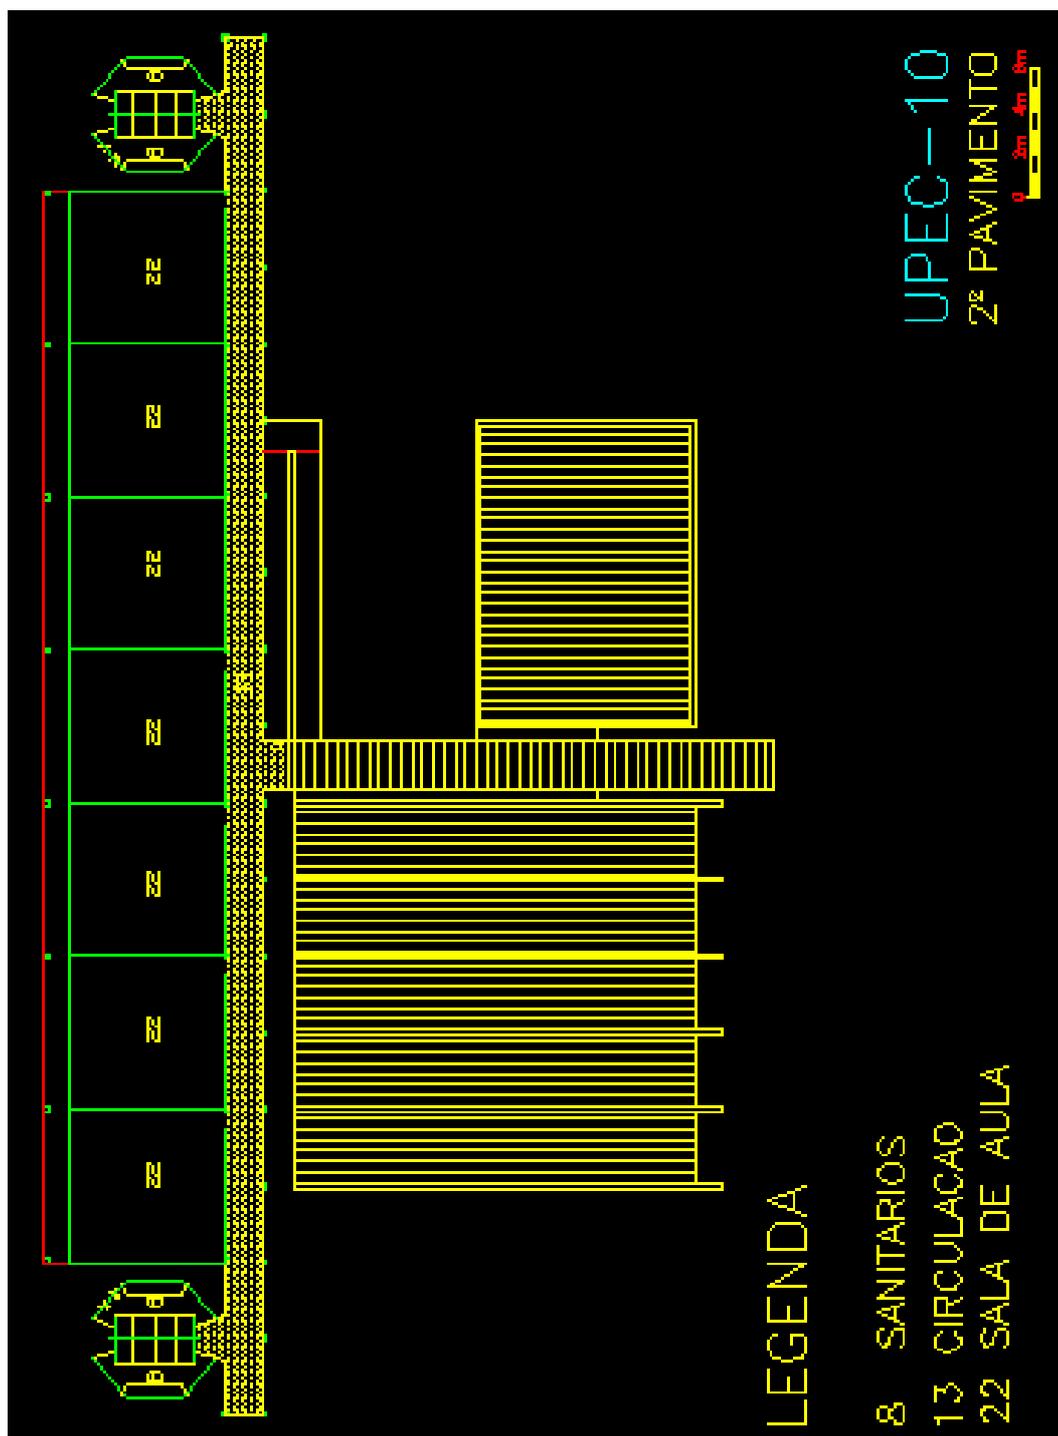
UPEC-10 / PLANTA 2º NÍVEL
